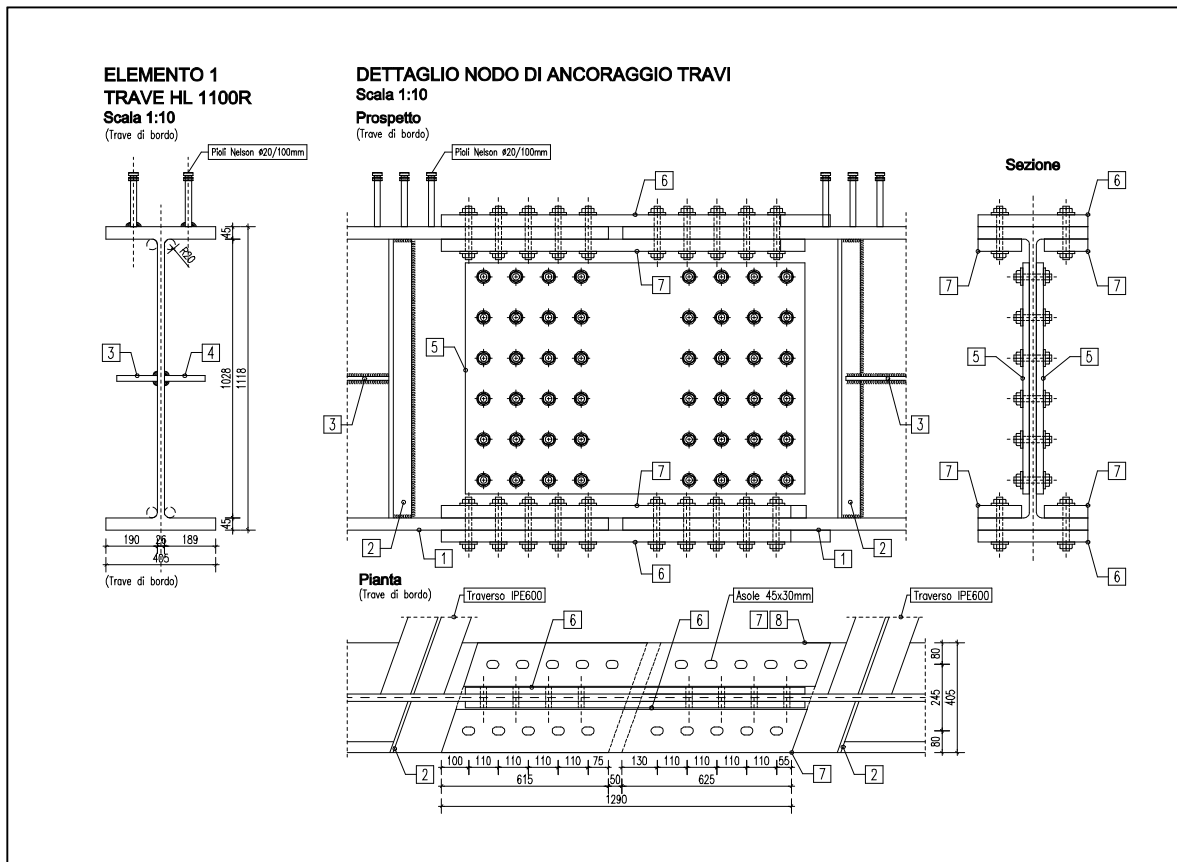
Particolare di collegamento tra i segmenti di travi di acciaio da realizzare pie' d'opera prima di varare le 5 travi intere.
